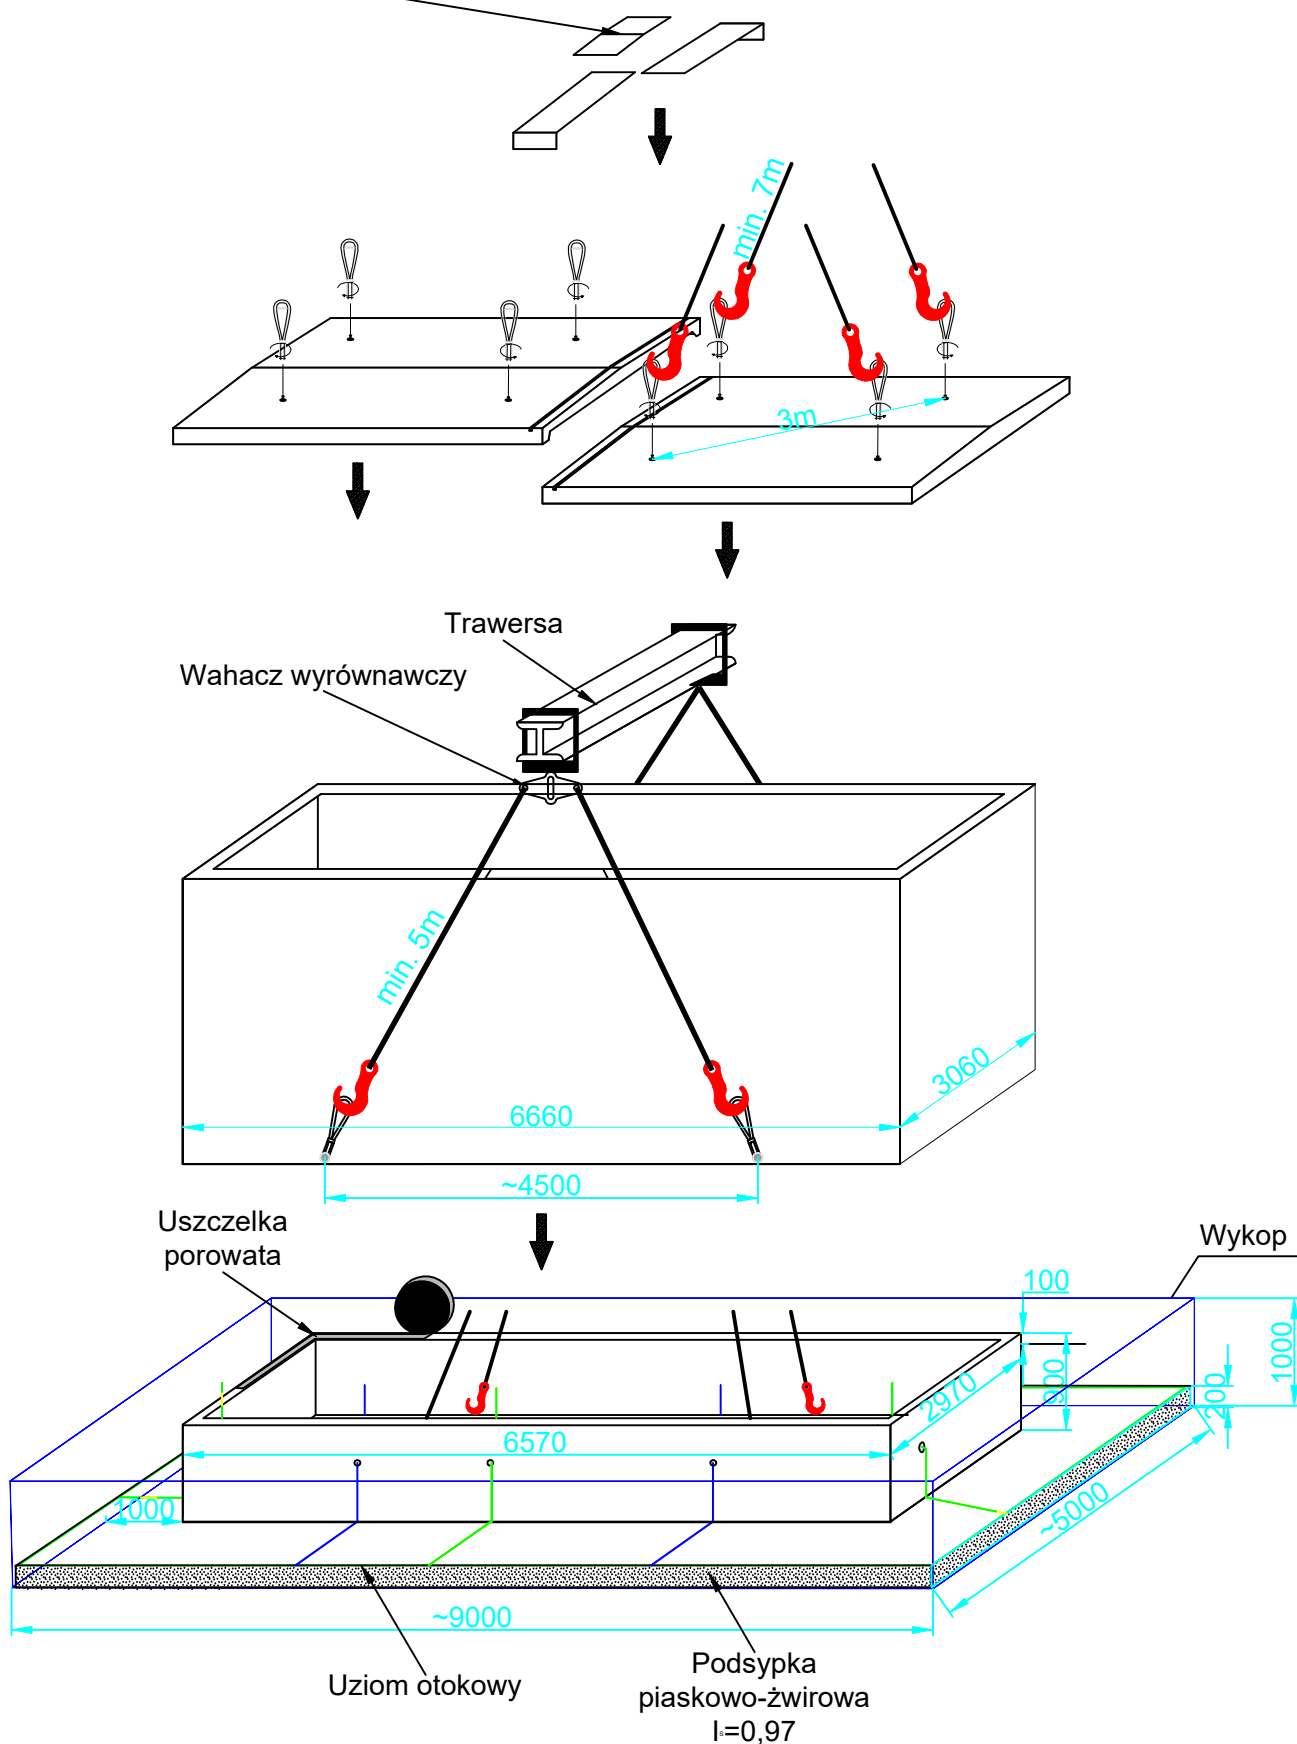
Przenoszenie elementów stacji - dachy metalowe (nakładka metalowa połączona z dachem betonowym).
